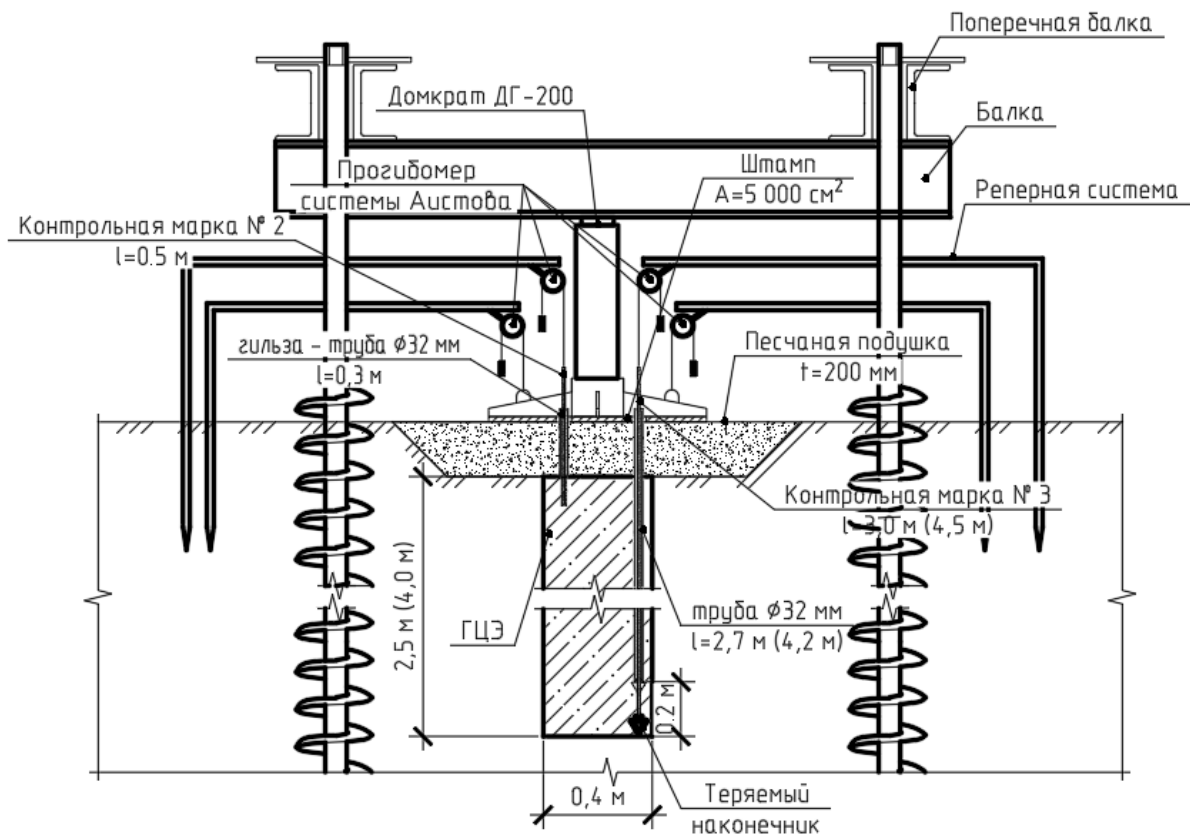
Схема установки для испытания плоским штампом армированного грунтового массива
